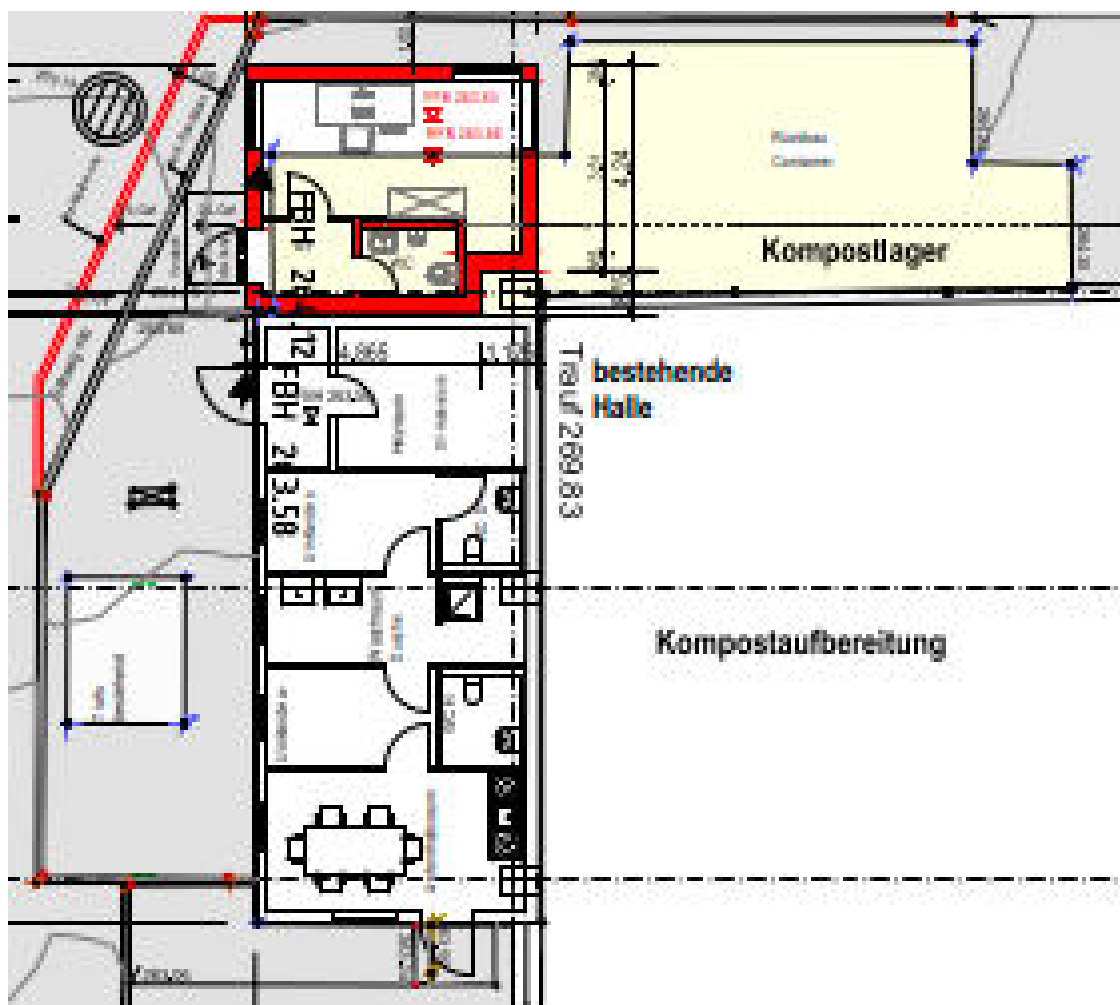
Anbau an bestehendes Betriebsgebäude
